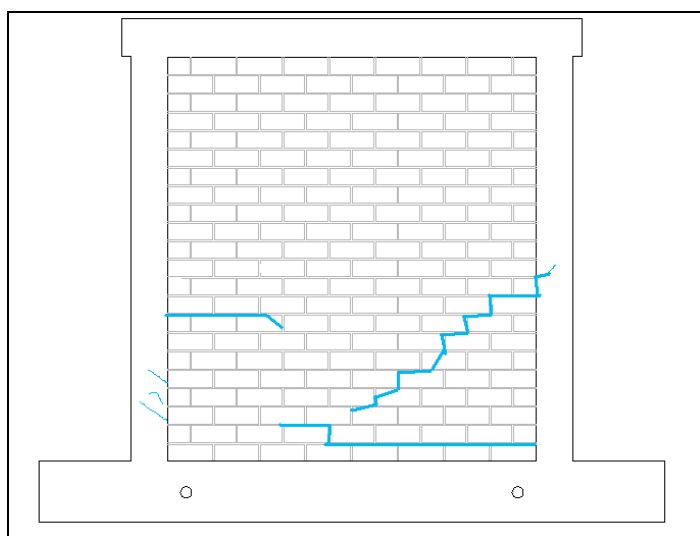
Fisuras producidas en la fase 3 del ensayo del Muro M1.
